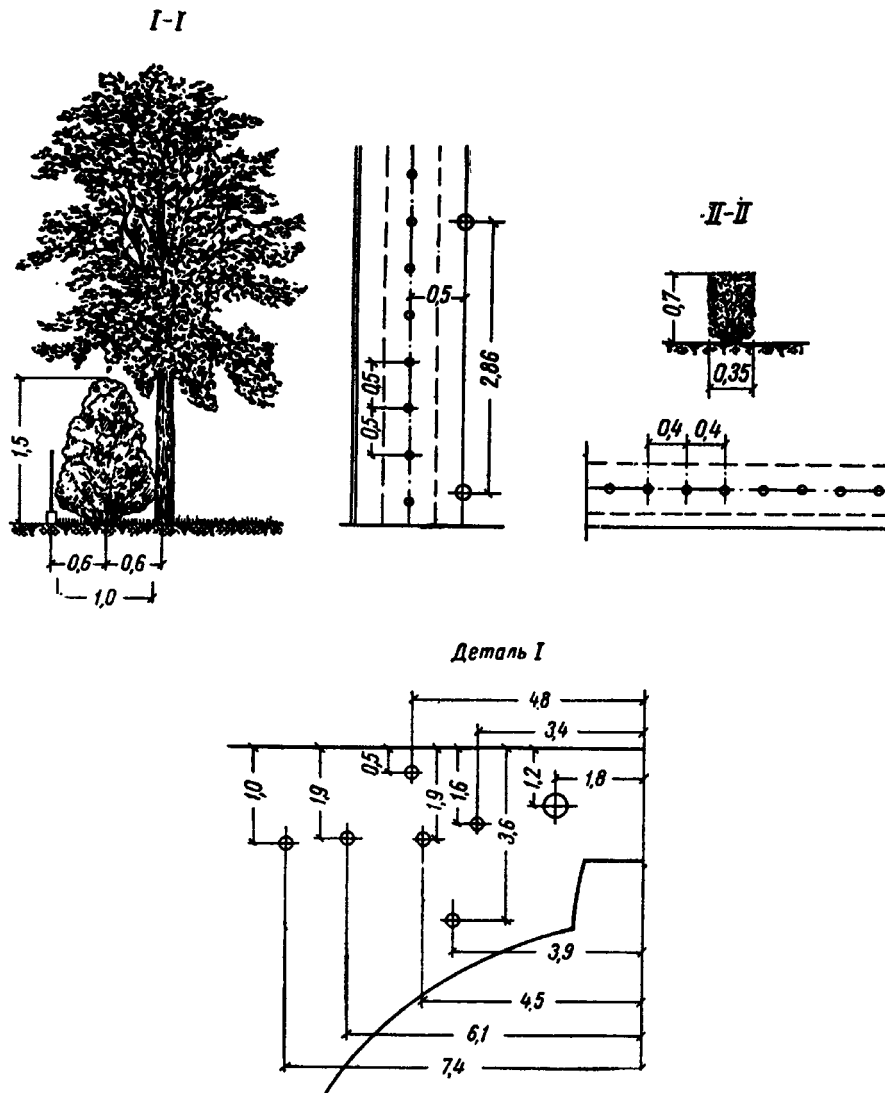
Пример рабочего чертежа по скверу (второй вариант выполнения). В данном чертеже места посадки растений установлены путем привязки точек посадки к осям, пересекающим сквер крест накрест, к краям дорожек и к границам участка. Кроме того, точки посадок установлены в прилагаемых к чертежу разрезах и деталях, одна из которых приведена на стр. 65. Пунктиром оконтурены группы однородных растений
